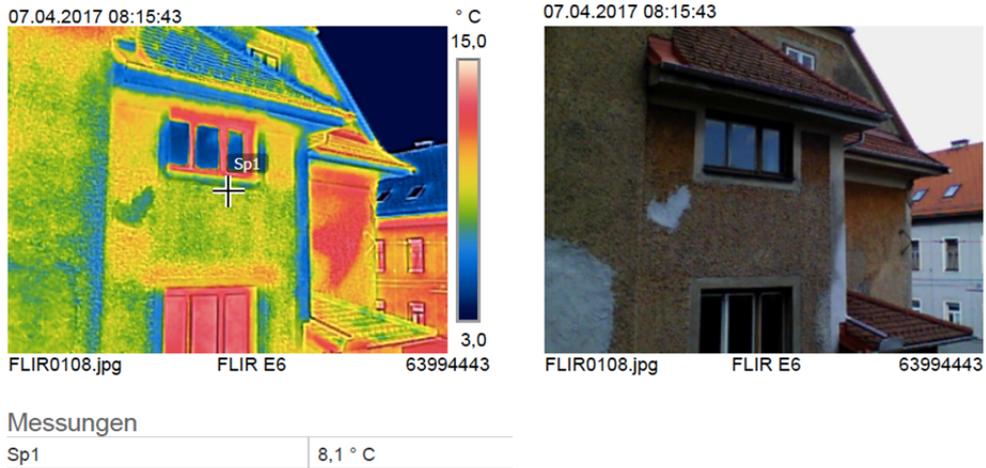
Wärmebild, Nordfassade, Stiegenhaus
